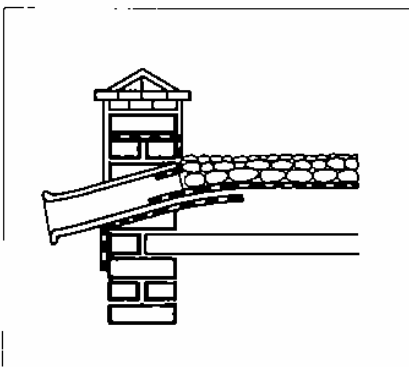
Etanchéité parfaitement soignée au départ et en sortie de gargouille.
